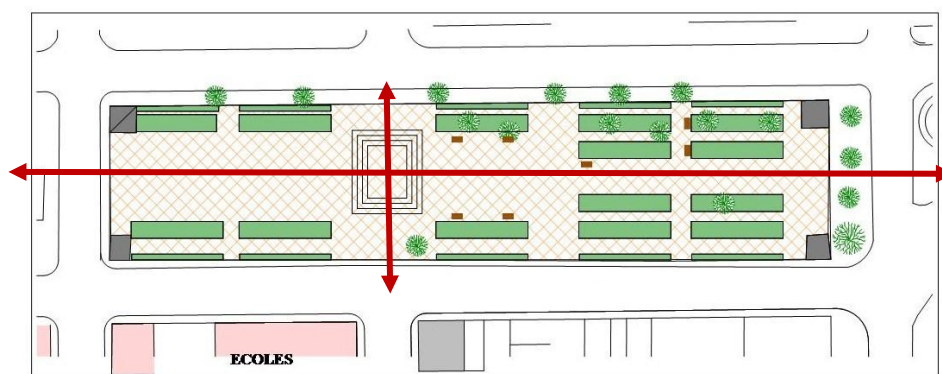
Plan de masse de la place Ben Boulaid, source POS du centre ville de Batna,
